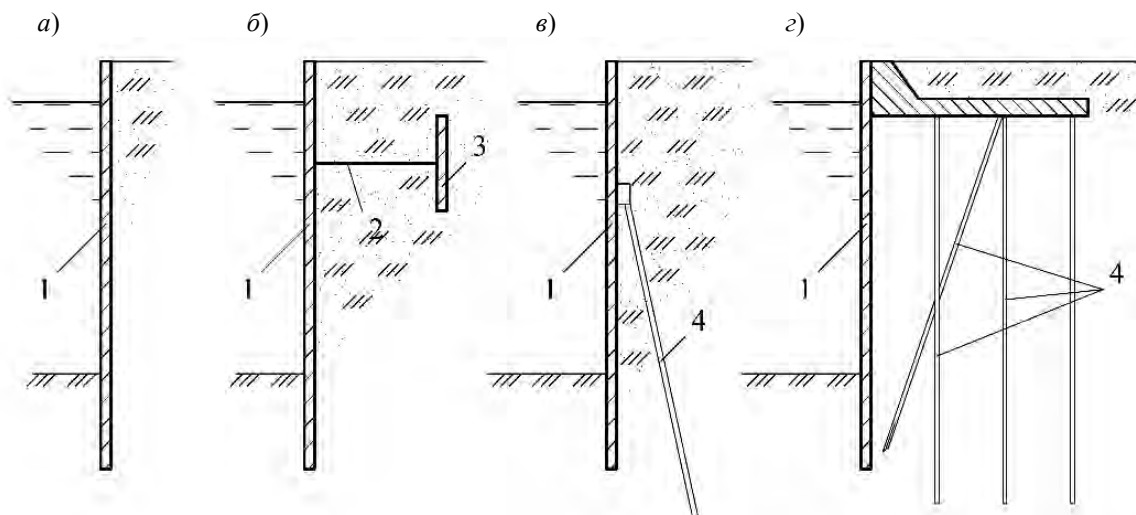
Шпунтовые и свайные подпорные стены: *а* – безанкерная; *б* – заанкеренная в плите; *в* – заанкерная наклонной сваей; *г* – на свайном фундаменте; 1 – шпунт; 2 – тяга (анкера); 3 – анкерная плита; 4 – сваи
